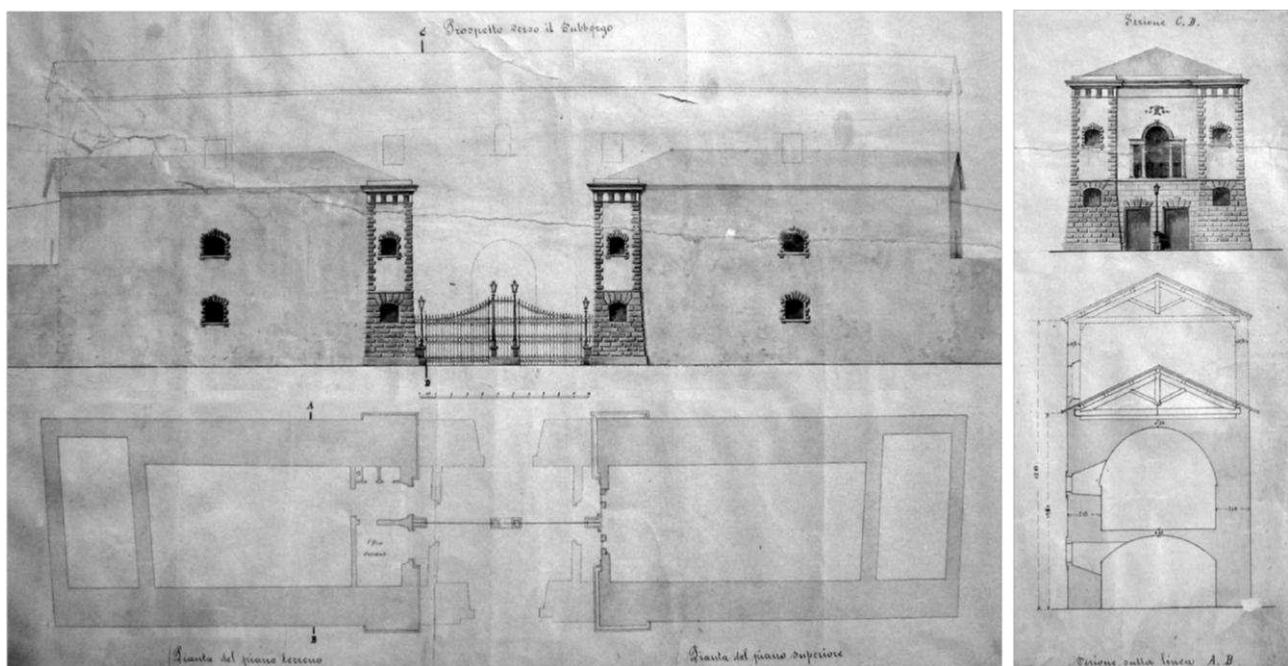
Il primo dei due “Progetti” definitivi con la demolizione completa dell'ultimo piano e il taglio della porta: pianta, prospetto, fronte interno e sezione trasversale, 1893 (Archivio di Stato di Arezzo, Pianta sciolte del Comune di Arezzo, 3 (Progetto di sistemazione della Porta S. Spirito nella città di Arezzo, progetto I’’)).
